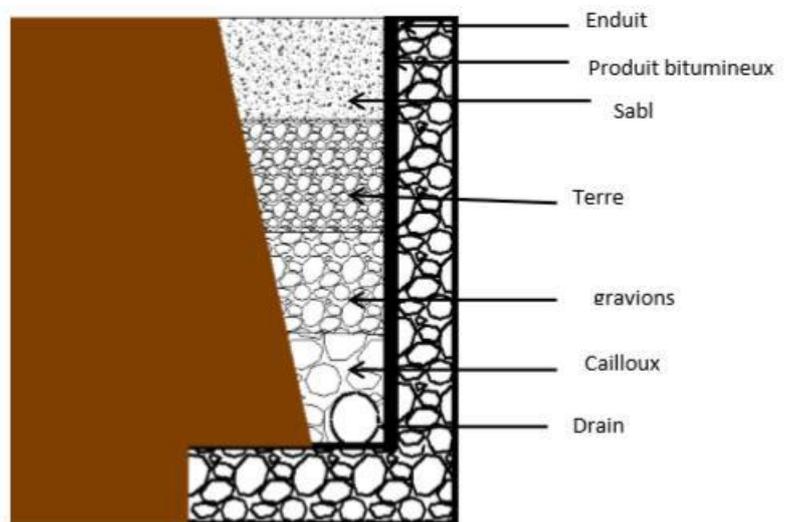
Détail d'un mur de soutènement. (Mémoire)
